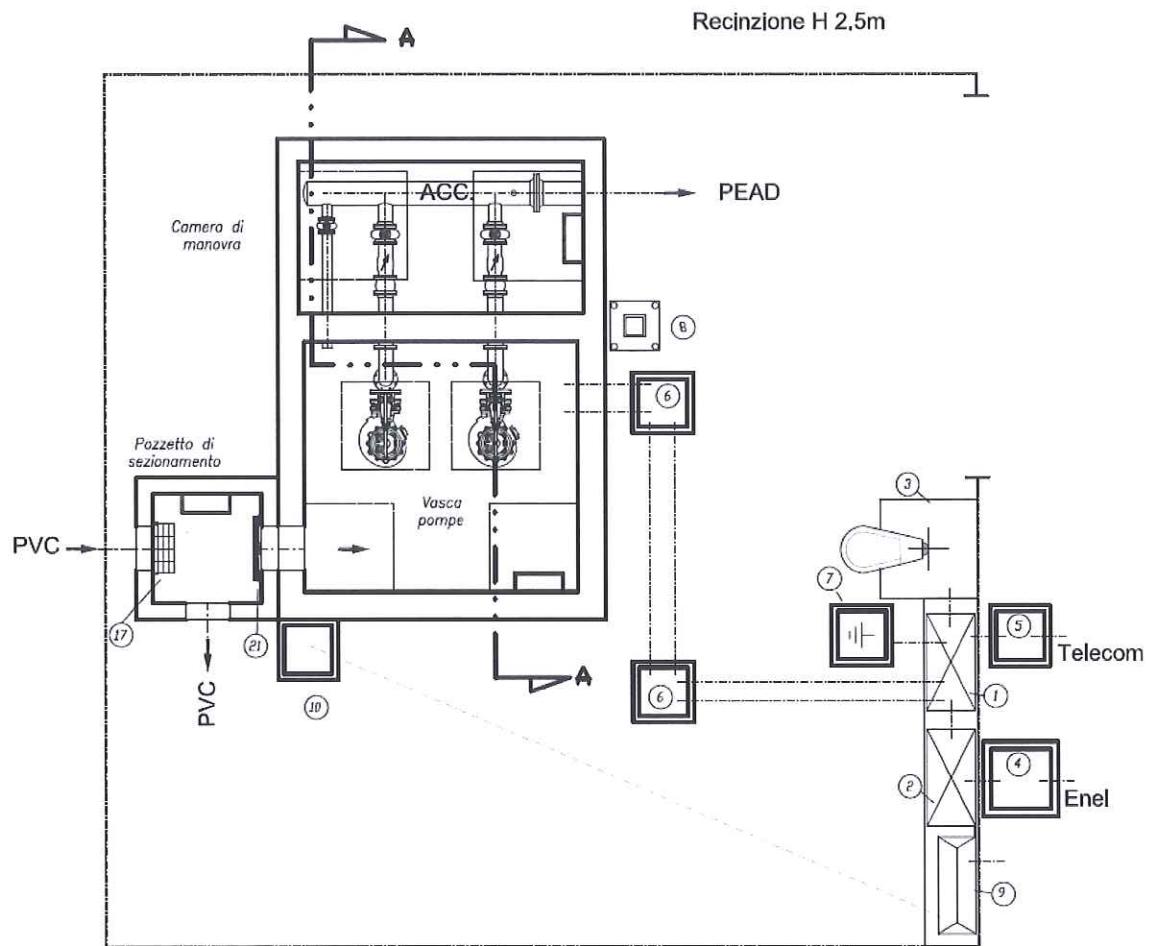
planimetria impianto di sollevamento fognario, schema tipo.
